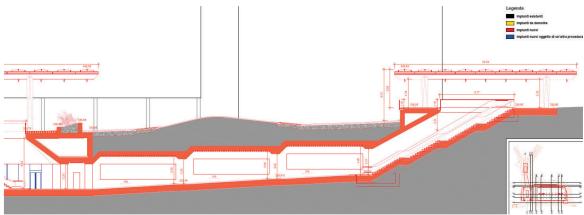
Sottopasso collegamento Besso Alta - Sezione
